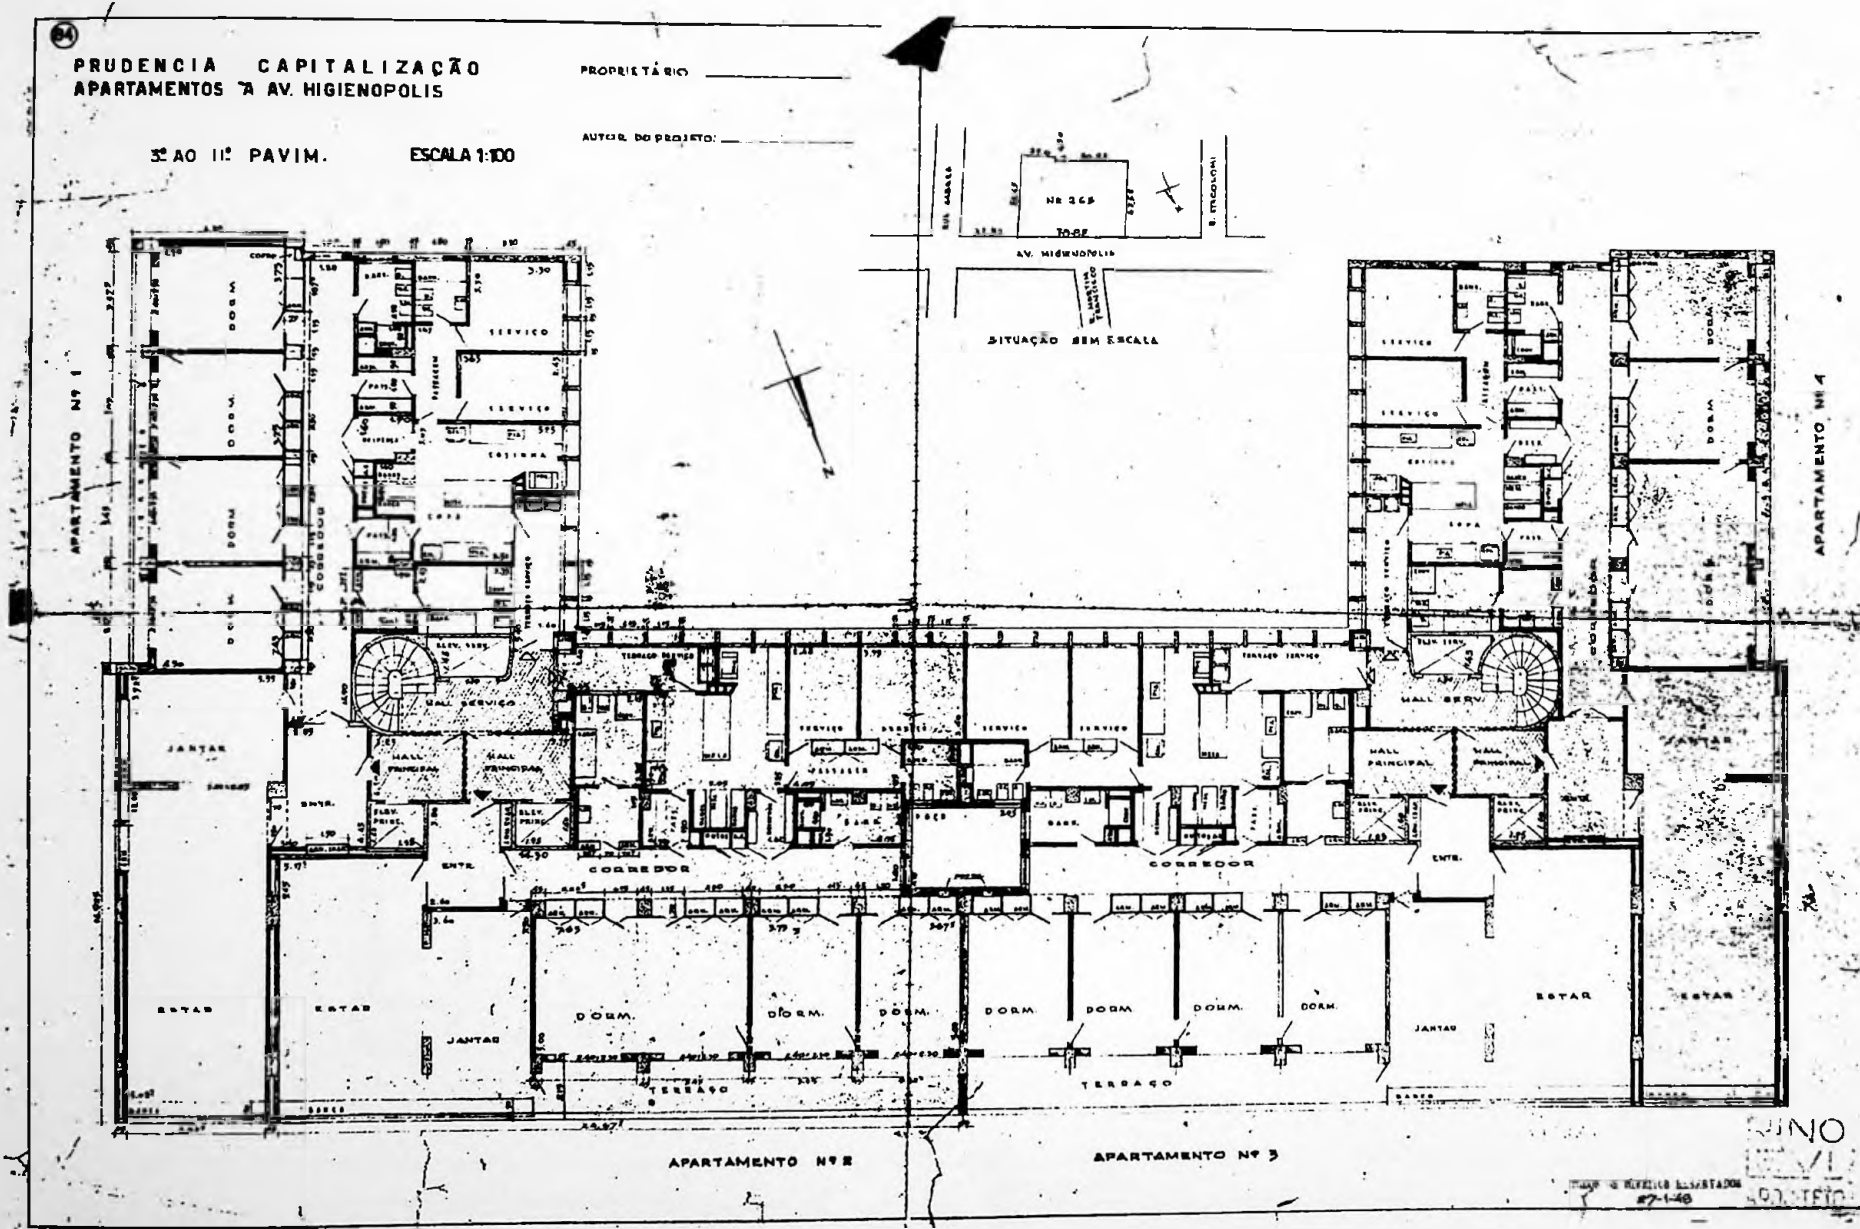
Planta 3º ao 11º pavimentos (27/01/1948)
